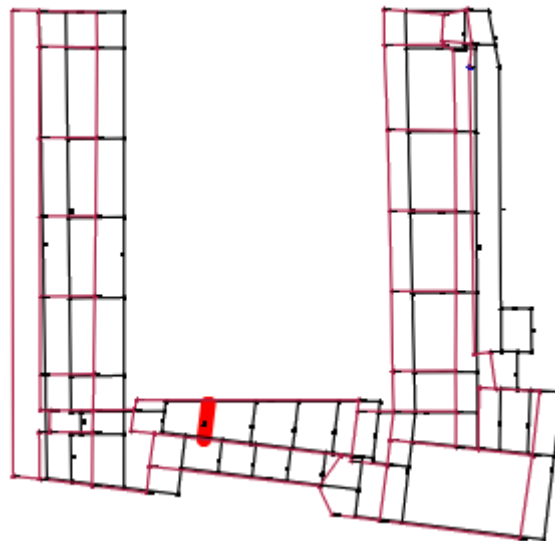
Disposizione in pianta della parete 26 e deformata di piano (linee rosse).
